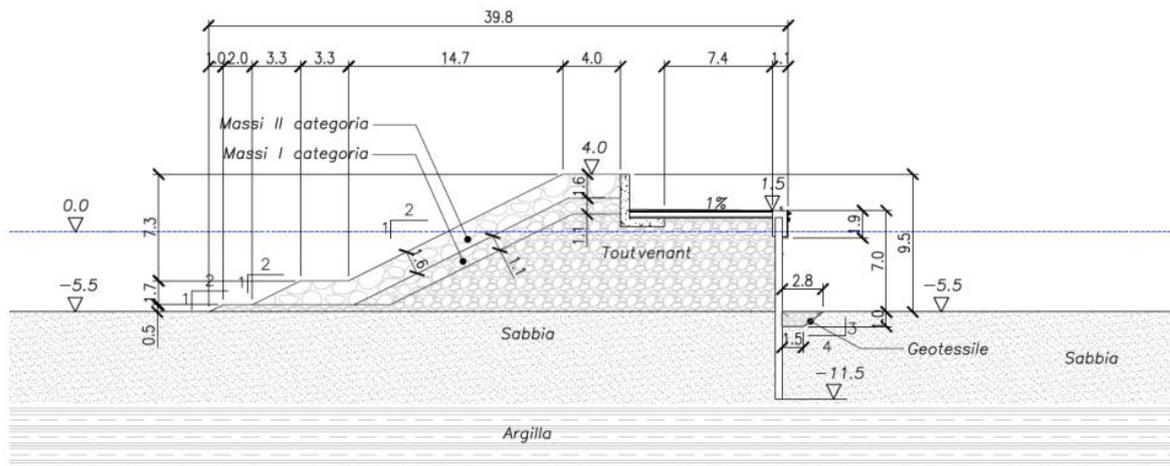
Sezione radice di collegamento a terra (Sez. O)
